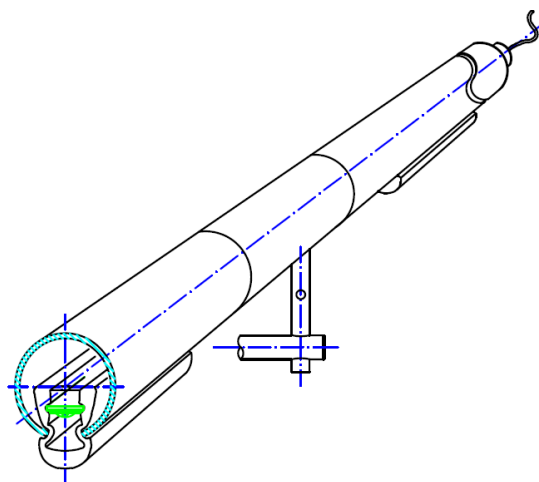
Prospetto sistema-corrimano illuminante: sequenza di apparecchio illuminante- modulo di fissaggio- apparecchio illuminante
